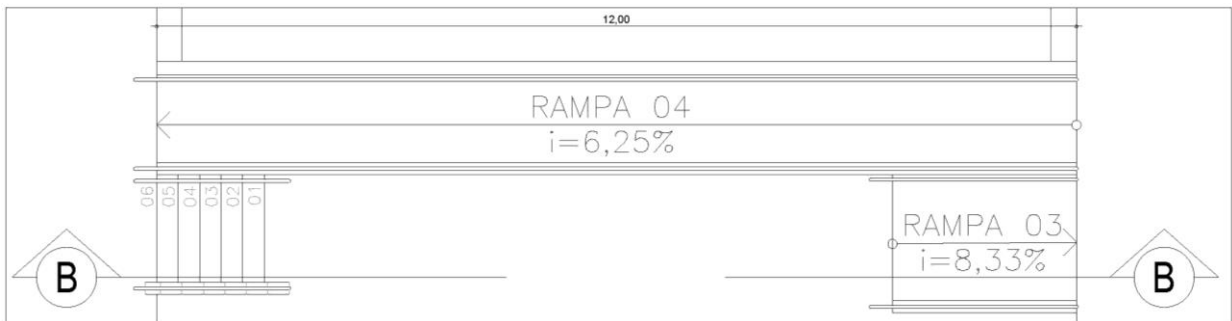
Planta Baixa das rampas 03 e 04. Fonte: SEINF-COPROJ.
